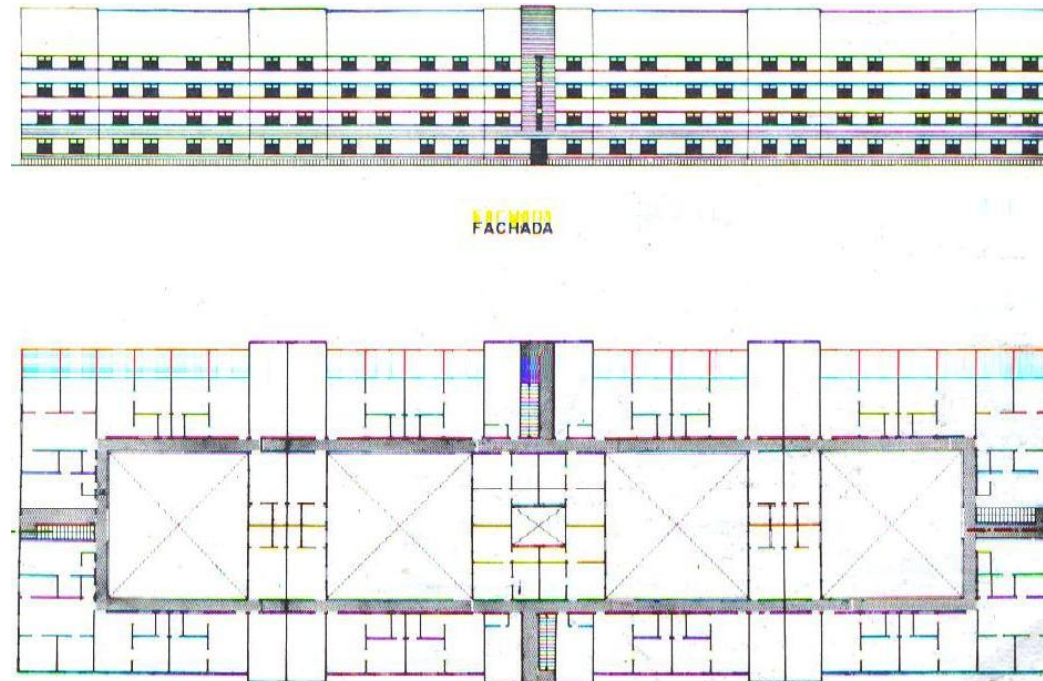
Fachada y Planta de Casa Colectiva vendida por el Municipio en 1954
